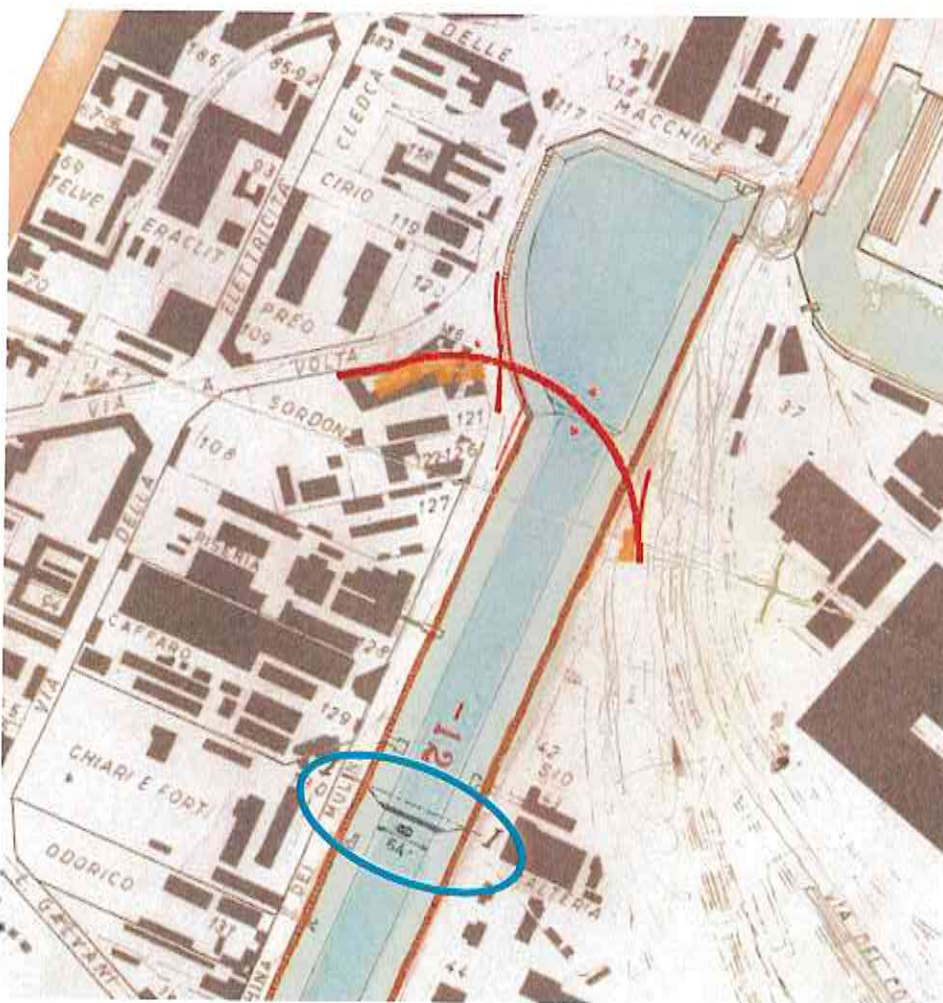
Planimetria PRP con evidenziata la Sezione I – I del Canale Industriale Ovest (blu) e sovrapposizione del tracciato ferroviario (tratto rosso).
